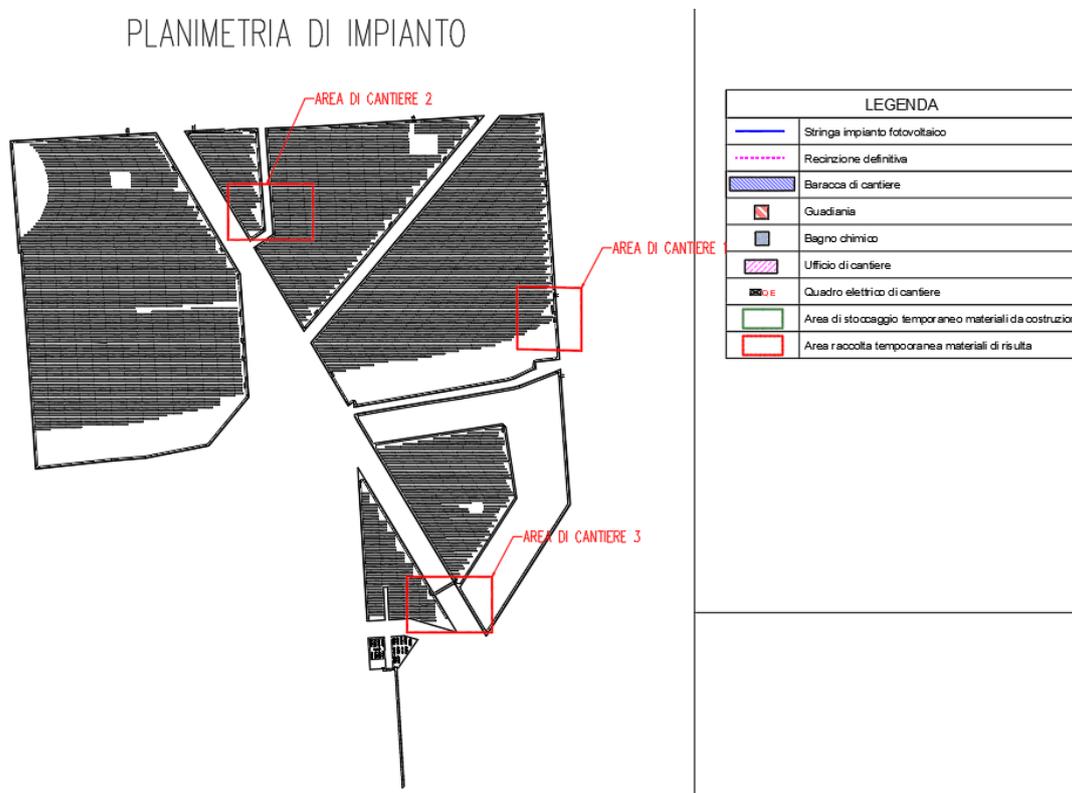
Layout di cantiere con individuazione dei percorsi su strade non asfaltate
